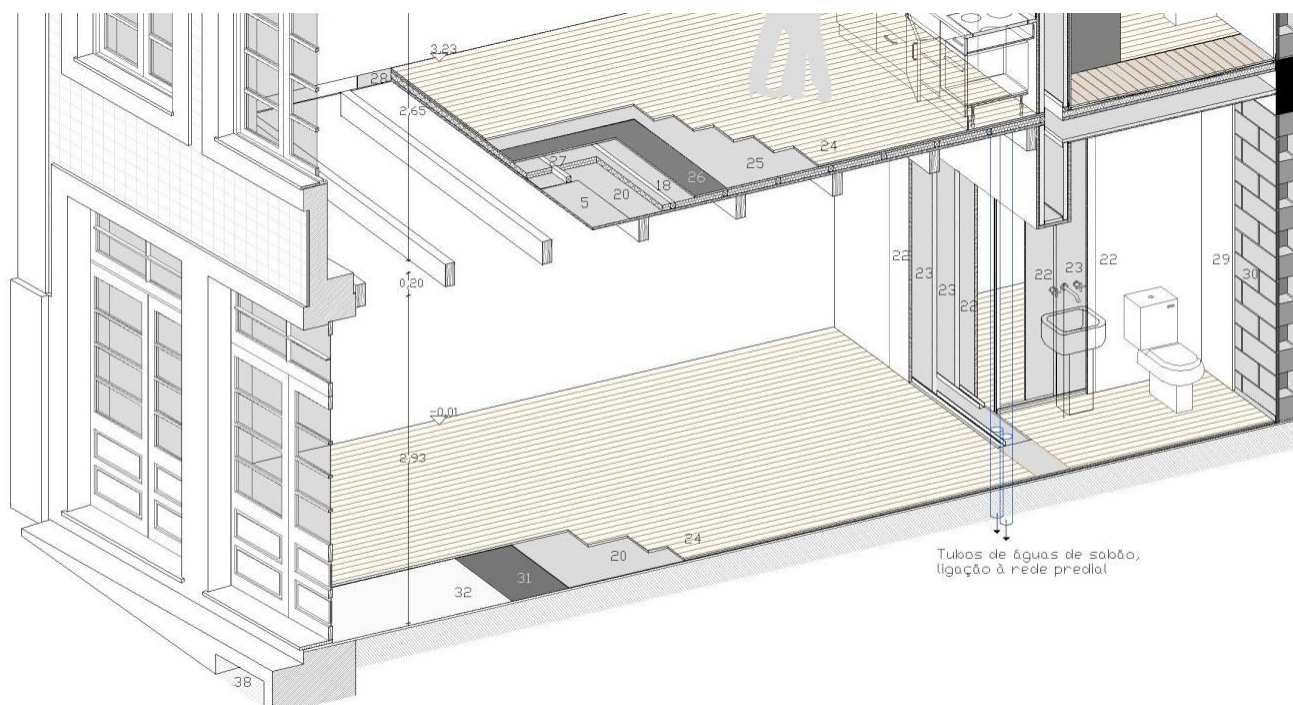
Corte perspectivado e caracterização construtiva da laje térrea, entre pisos e paredes divisórias
